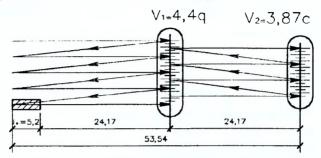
Разработка и перемещение грунта бульдозером по схеме с промежуточными валками
